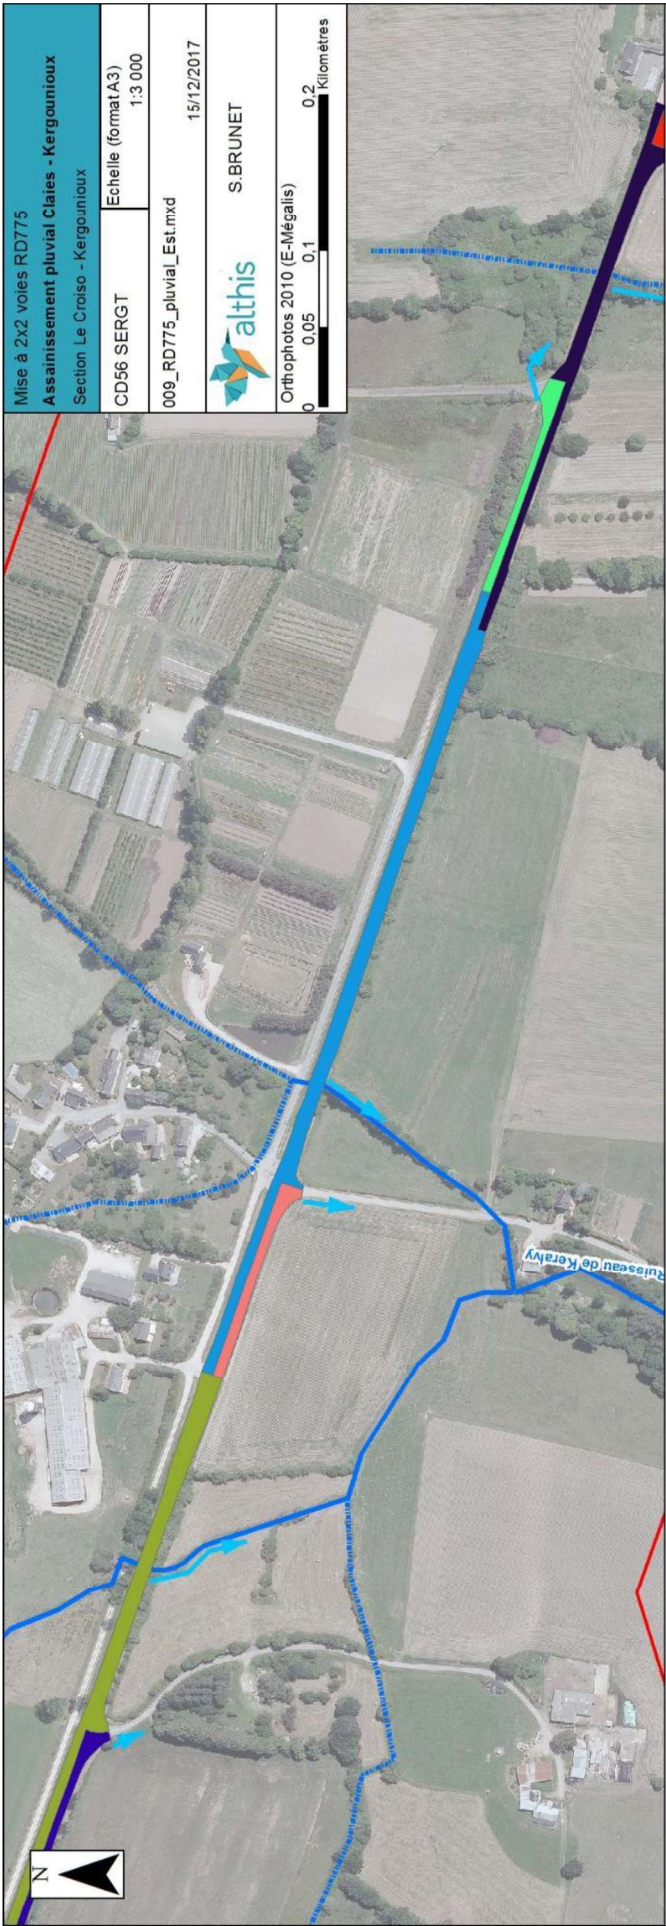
Assainissement pluvial de la plateforme existante – partie centrale
